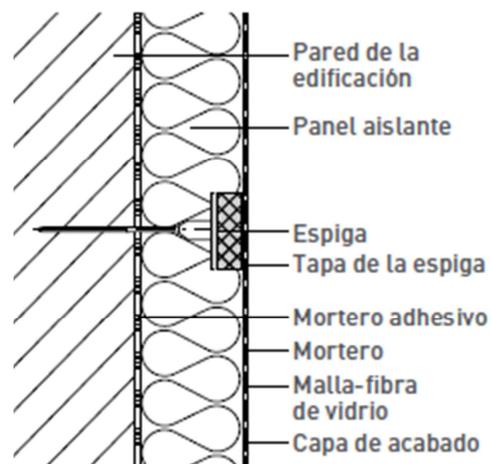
Fotografía de la instalación de espigas en un edificio. Imagen 47. Sección constructiva de la instalación de una espiga.
